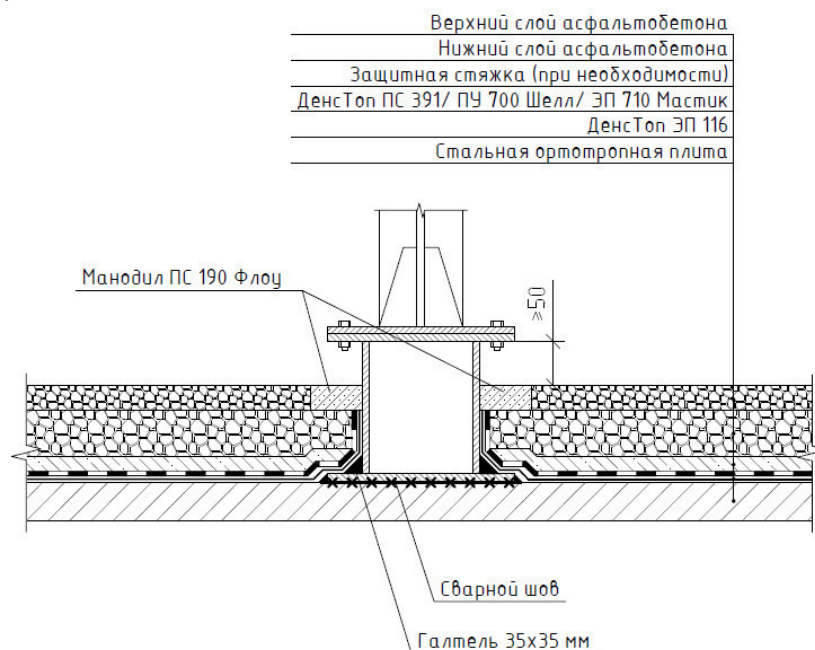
Примыкание гидроизоляции к стойкам барьерного ограждения
